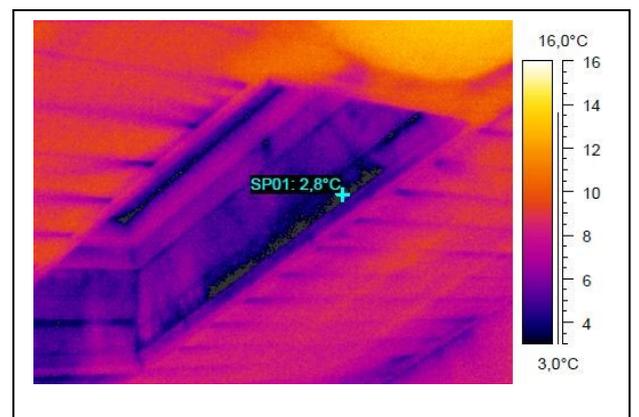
Dachflächenfenster während Blower Door (Es wird kalte Luft durch undichte Bauteile angesaugt)
